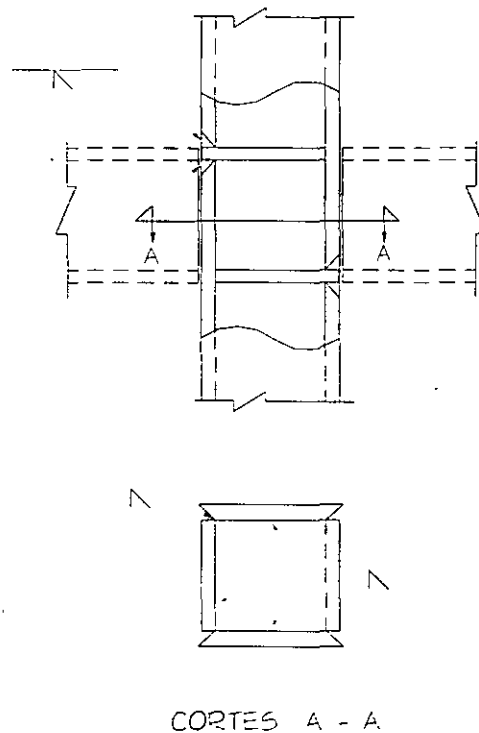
Colocación de atiesadores horizontales en una columna en cajón
